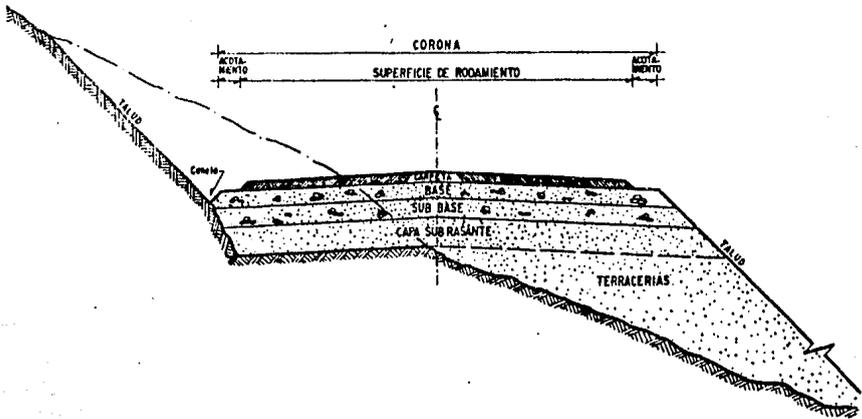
Sección transversal típica de un pavimento flexible en una sección en balcón.
